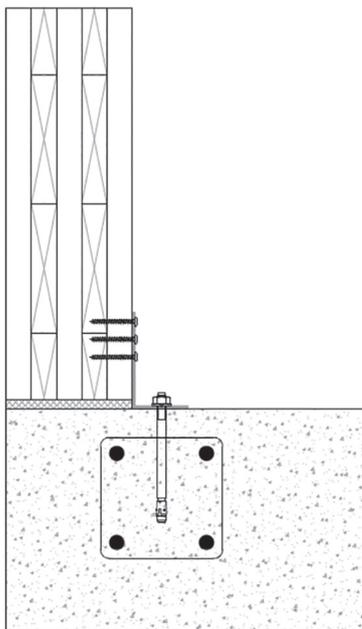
Assemblage mur-support béton par connecteurs tridimensionnels
